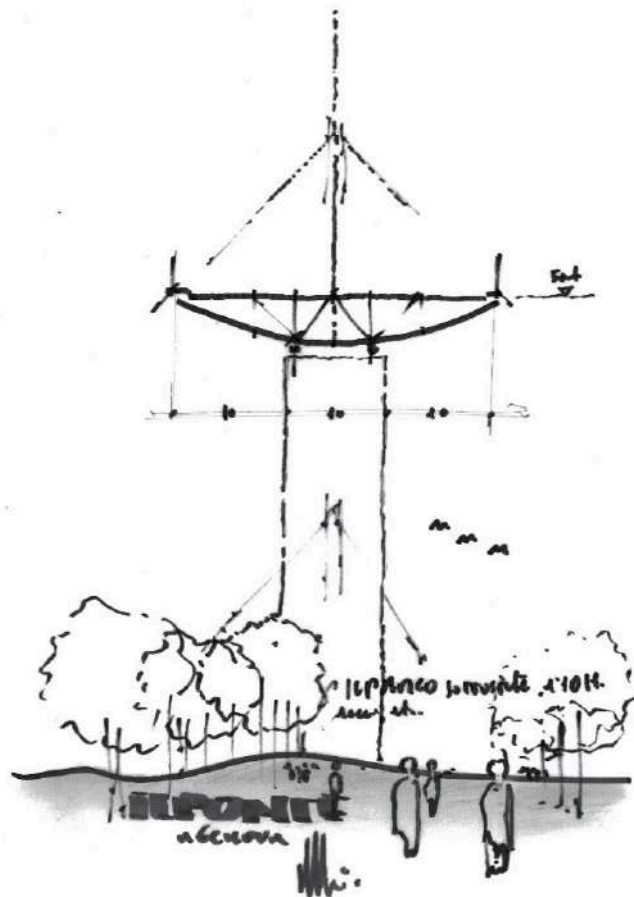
Croqui preliminar do arquiteto Renzo Piano. Fonte: Renzo Piano Building Workshop
